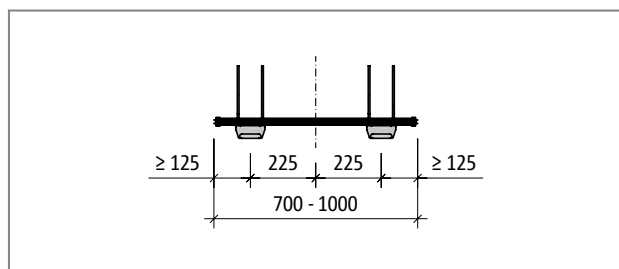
Schöck Tronsole® tipo T-V2-H...-L700 - L1000, pianta del prodotto
